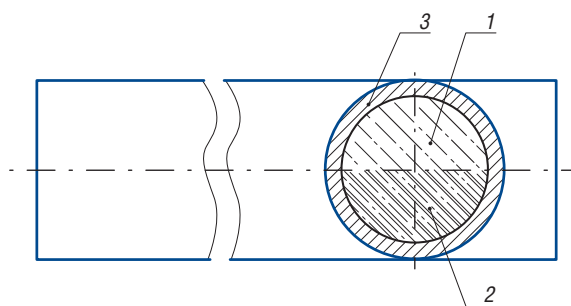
Трубобетонная балка с асимметрично предварительно напряженным бетонным ядром: 1 — бетон (неармированная часть бетонного ядра); 2 — предварительно напряженный железобетон (армированная часть бетонного ядра); 3 — старогодная нефтегазовая труба
